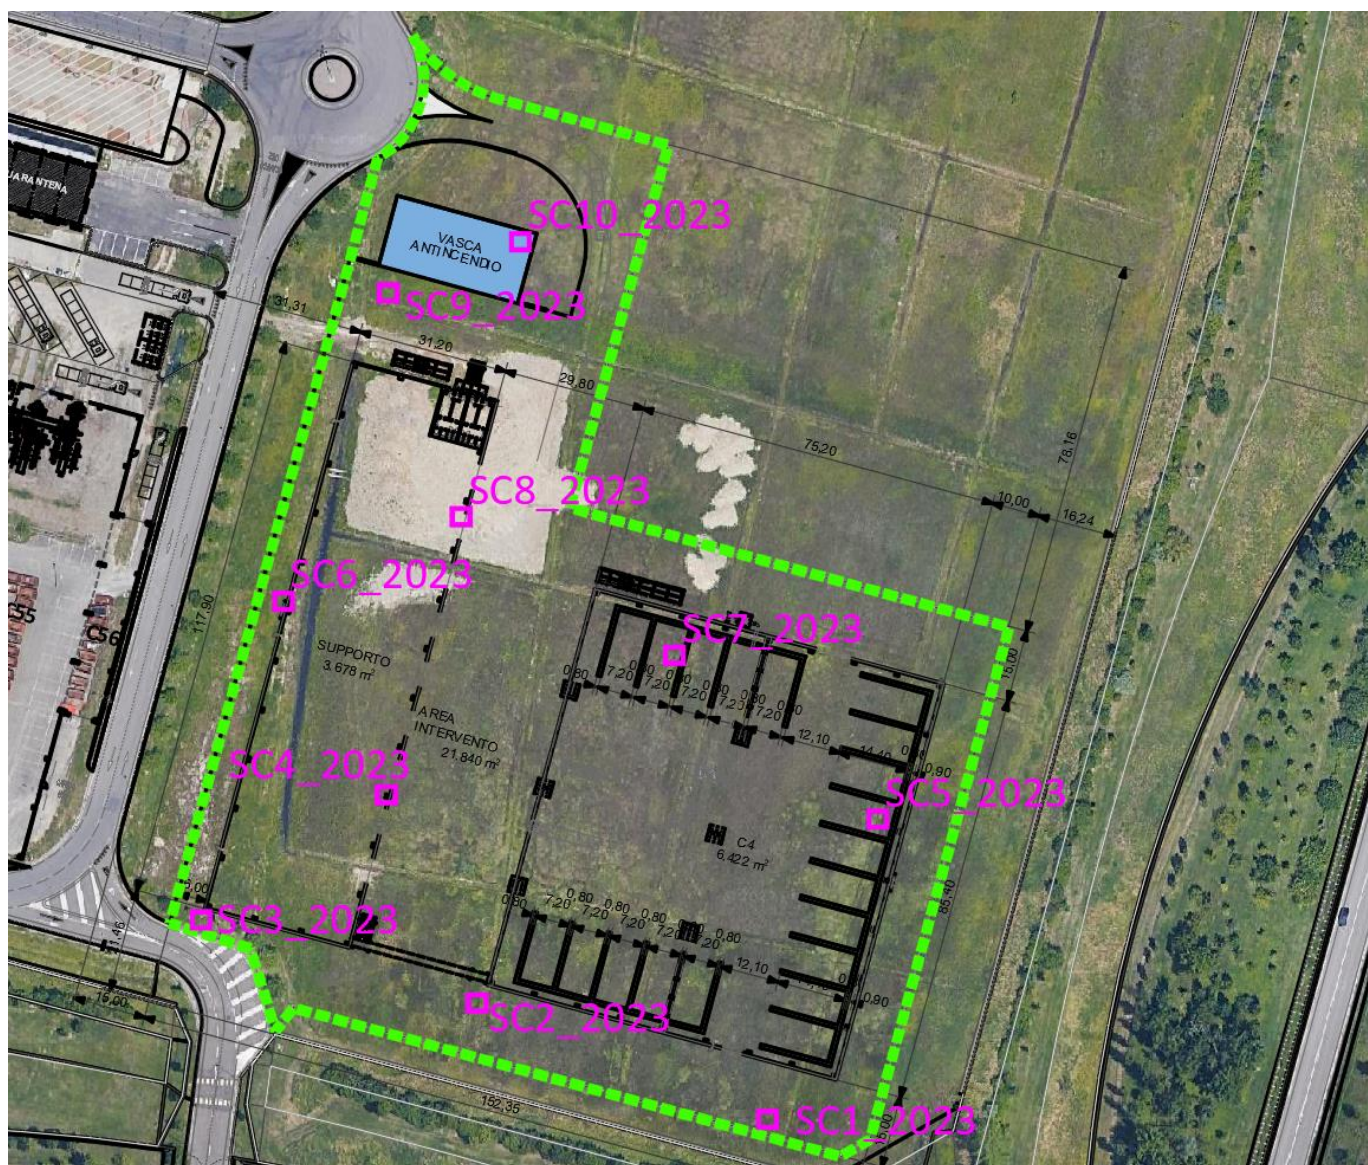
Ubicazione delle verticali di campionamento su base ortofoto Google Earth e Planimetria di progetto (semplificata) da Tavola A.02 "Planimetria generale di Progetto".
